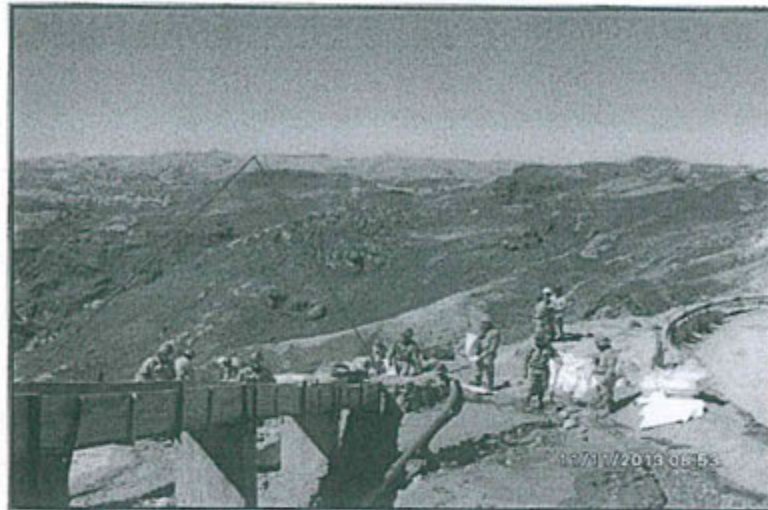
Tramo de tubería contenido en canal impermeabilizado
